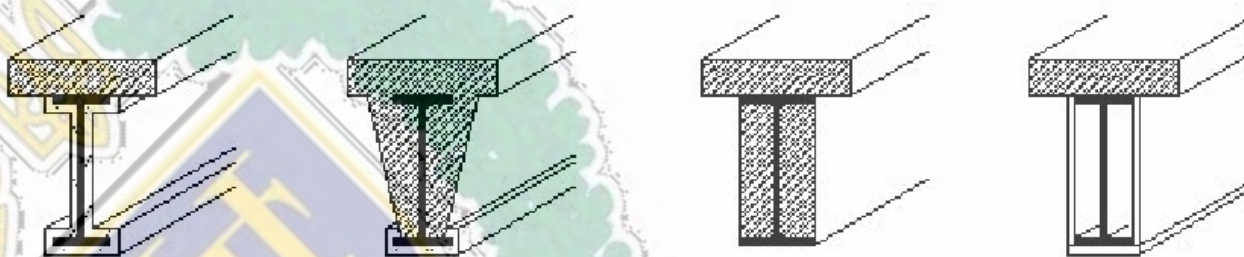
Сталезалізобетонні комбіновані балки перекриття, в яких конструкційний сталевий профіль оббетонований з двох боків, чи повністю бетоном, розчином чи іншим матеріалом.
